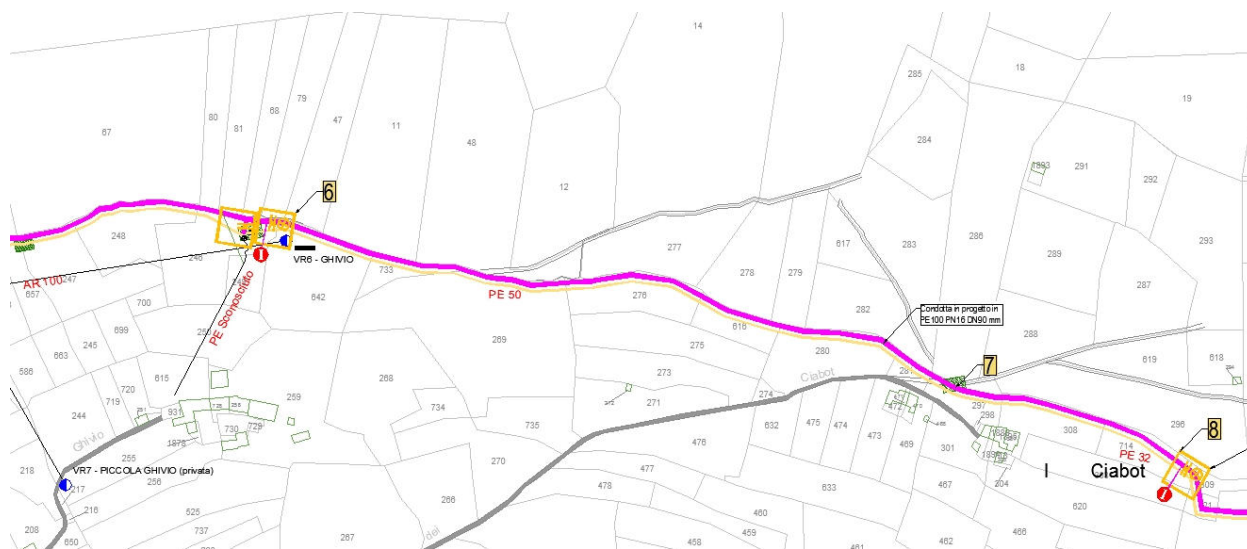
nuova condotta a progetto tra la Sezione 6 e la Sezione 8 su stralcio planimetria catastale.
